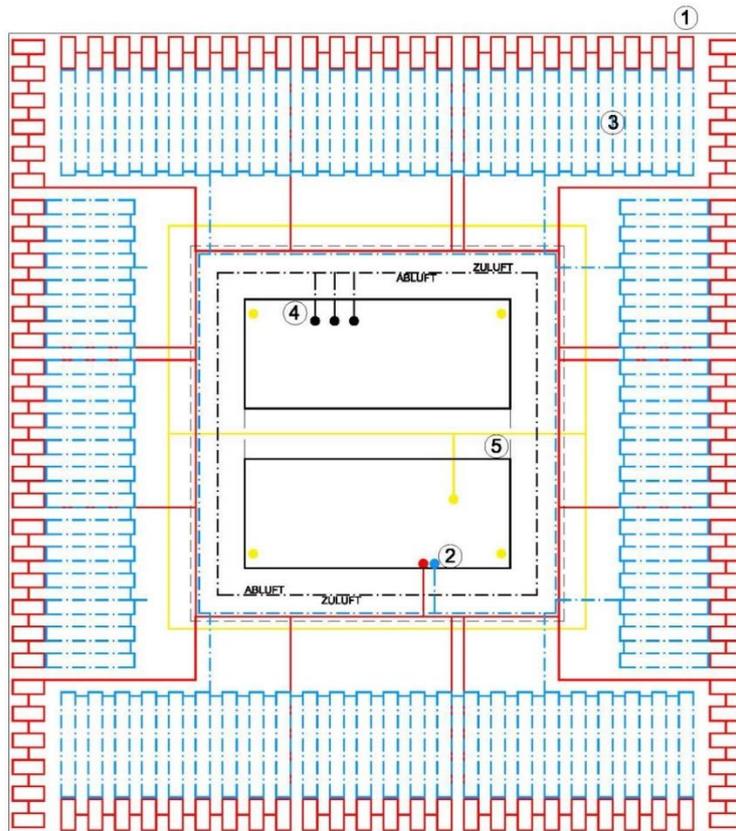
Schemagrundriss, Schnittstellen Haustechnik
